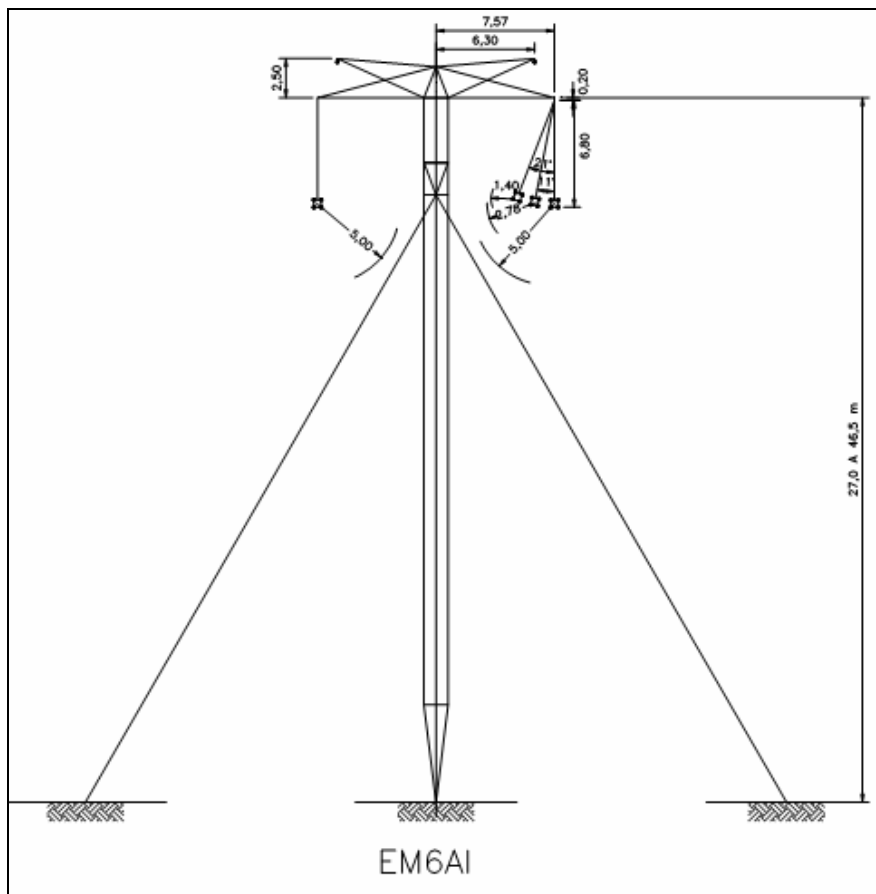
Vista frontal de torre estaiada tipo EM6AI
